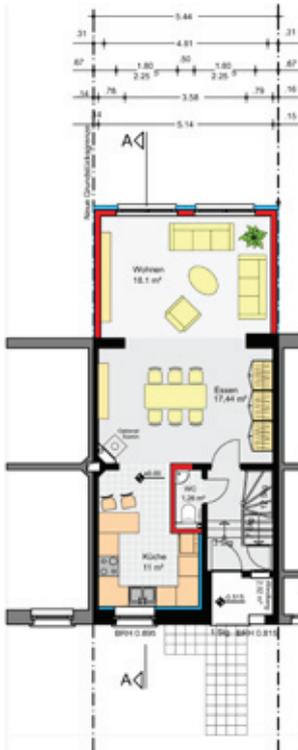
Grundriss Erdgeschoss Hausgruppe
